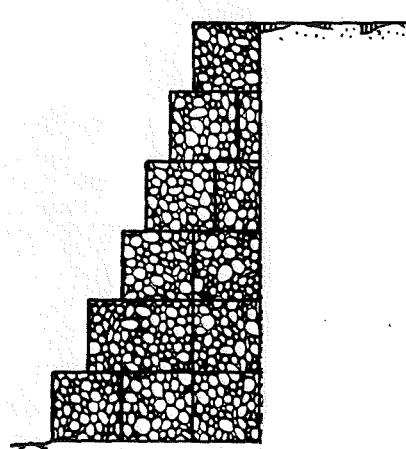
Muro de Gaviones con Intradós escalonado y trasdós vertical.
